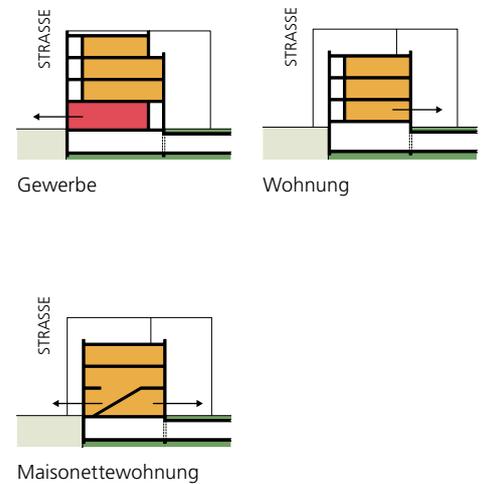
Schema: Erdgeschossstruktur zur Römerstraße (Ostseite) mit beispielhaften Nutzungen
